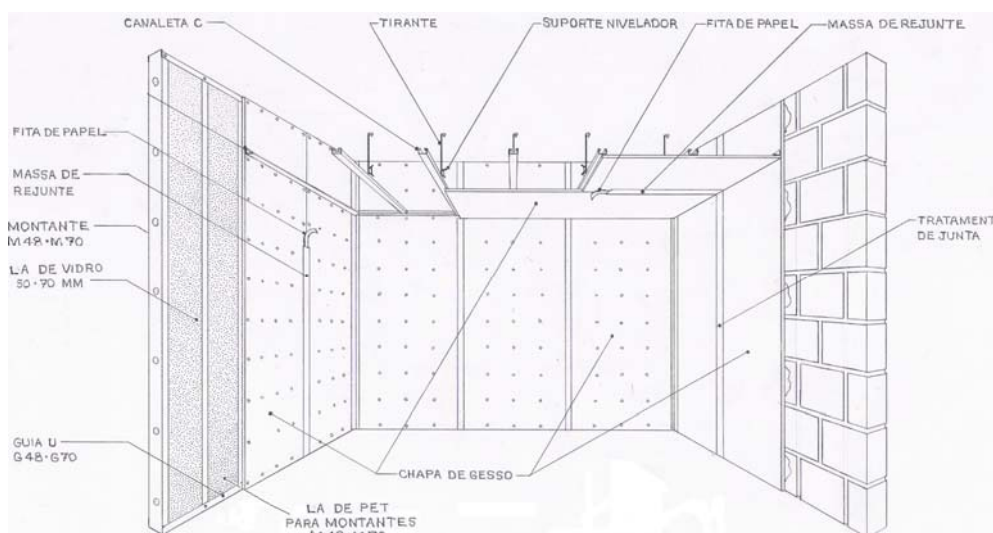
Ilustração do sistema construtivo em chapas de gesso para drywall
